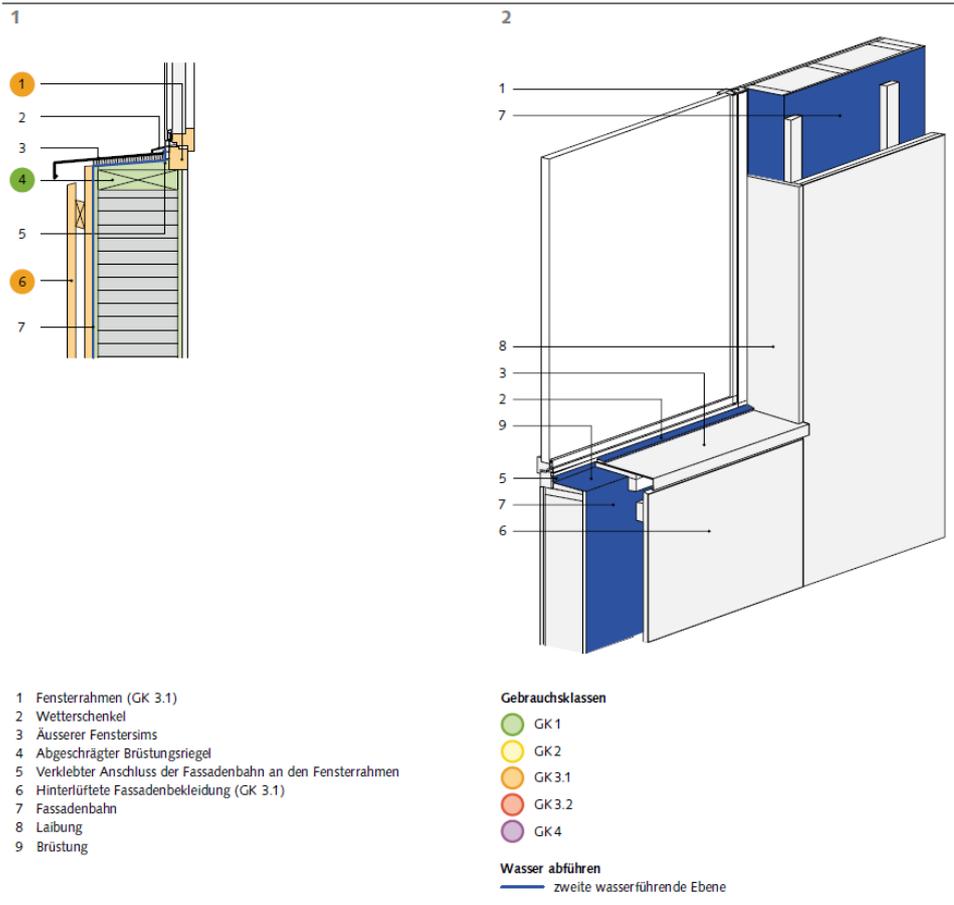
Anschlussdetail bewittertes Fenster [2]
